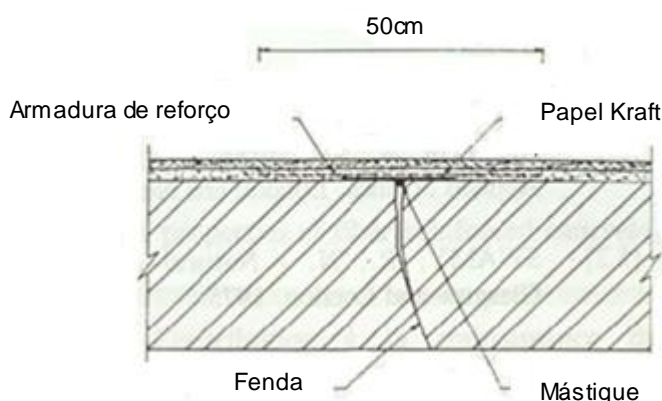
Representação esquemática de um reboco armado para reparação de uma fenda [63]
